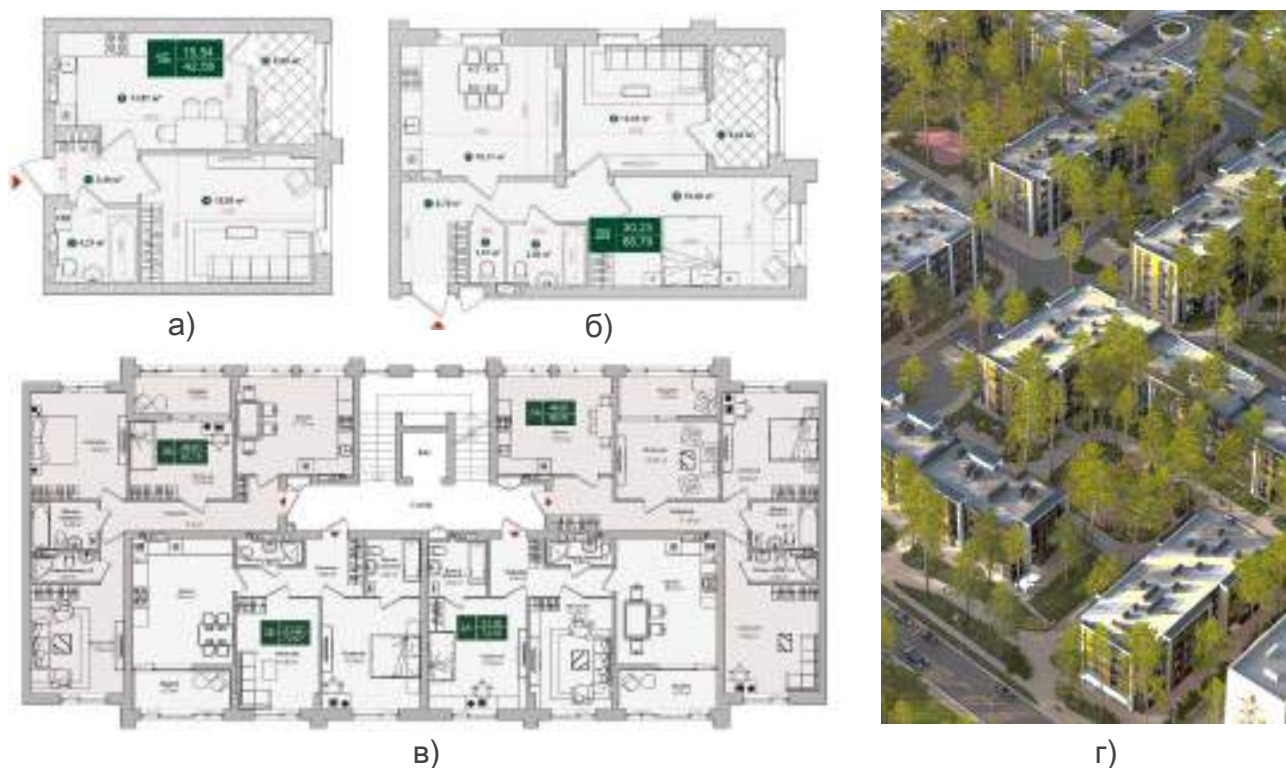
ЖК Forest Park, Київ. ZIM Group 2018-2025 а. Приклад планування 1-кімнатної квартири б. Приклад планування 2-кімнатної квартири в. План типового поверху г. Загальний вигляд [32].
